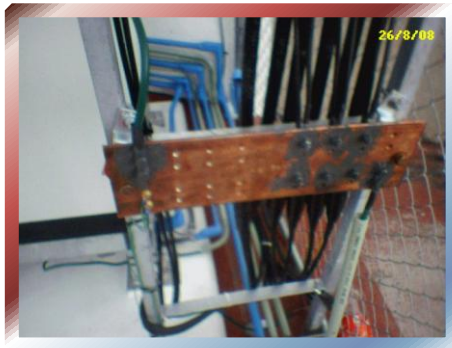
Aterrizaje de feeder's a BET y conector tierra.
